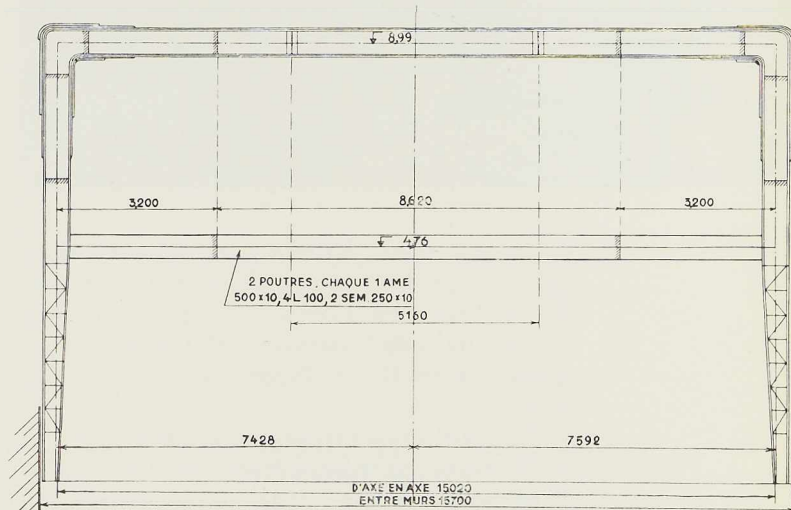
Certains portiques portent également l'entresol par l'intermédiaire d'une poutre.
